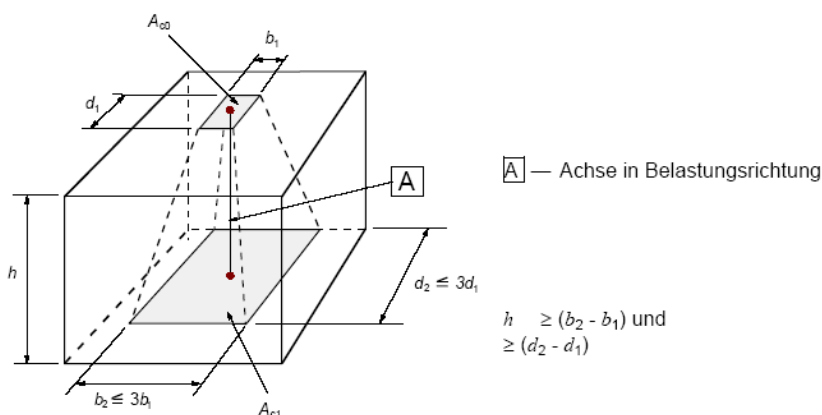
Ermittlung der Flächen für Teilflächenbelastung
